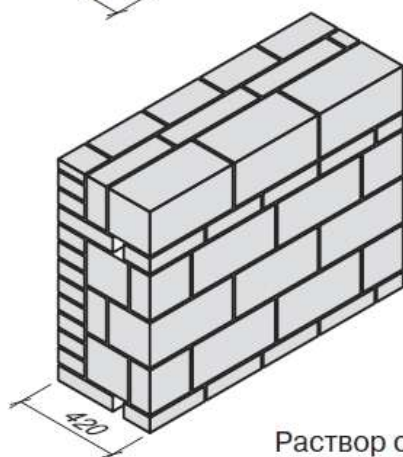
Кладка из бетонных камней (блоков) с лицевым слоем из кирпича
